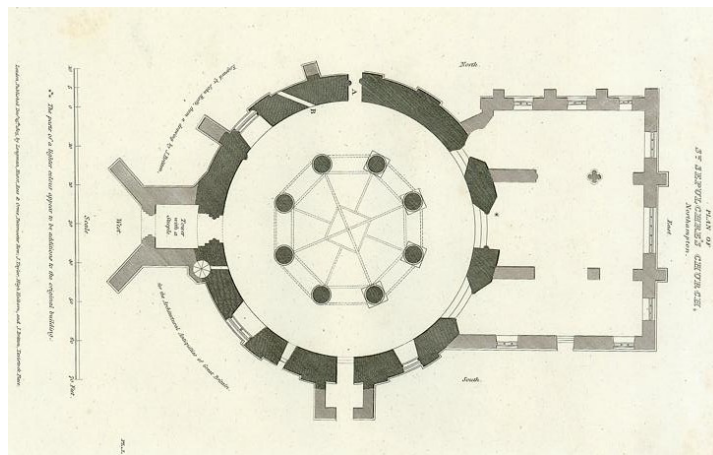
Grundriss, Heilig-Grabkirche, Northampton, Anfang 12. Jh.-14. Jh.
